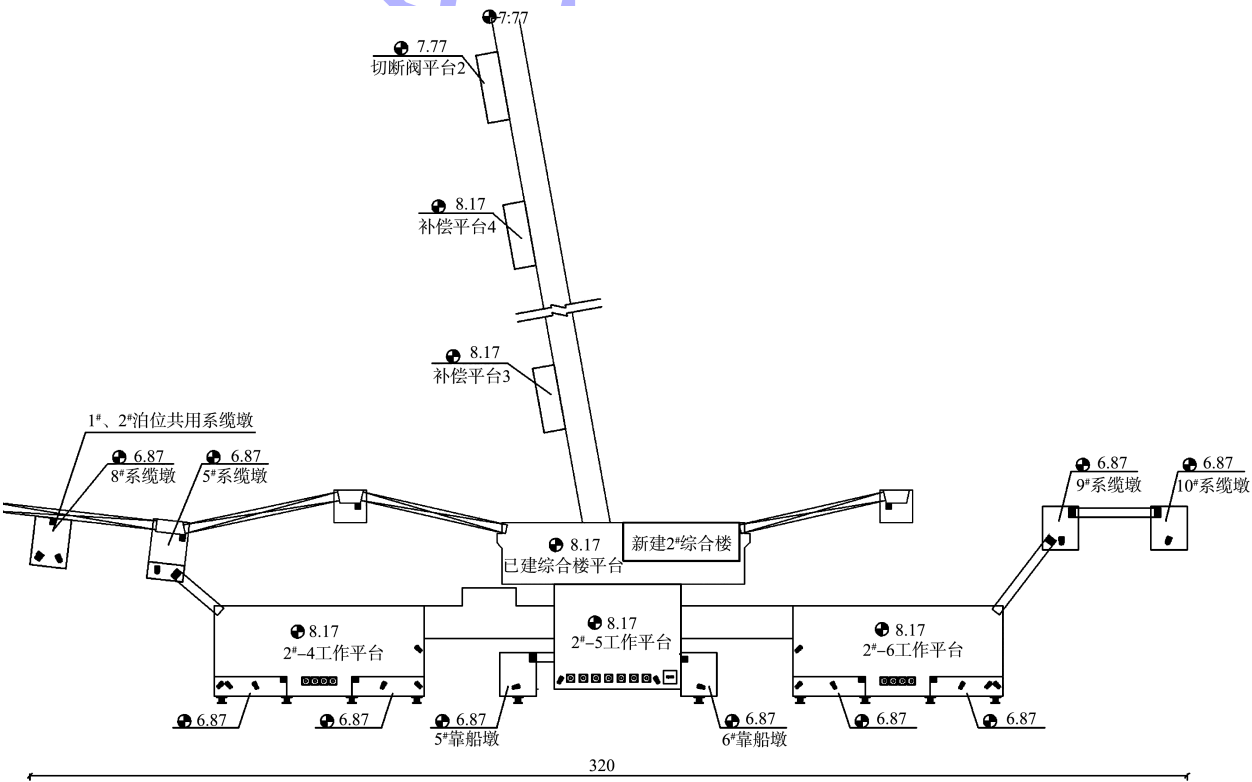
改扩建后 2[#]泊位平面布置 (单位: m)
